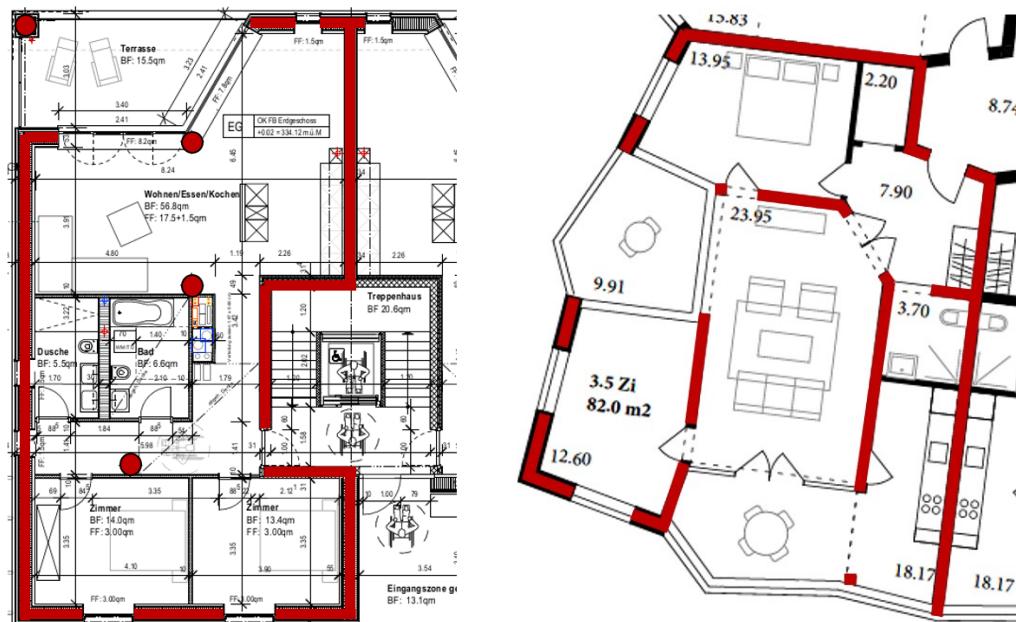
Unregelmässige Grundrisse mit Decken-Auflagern auf tragenden Wänden und einzelnen Stützen.
